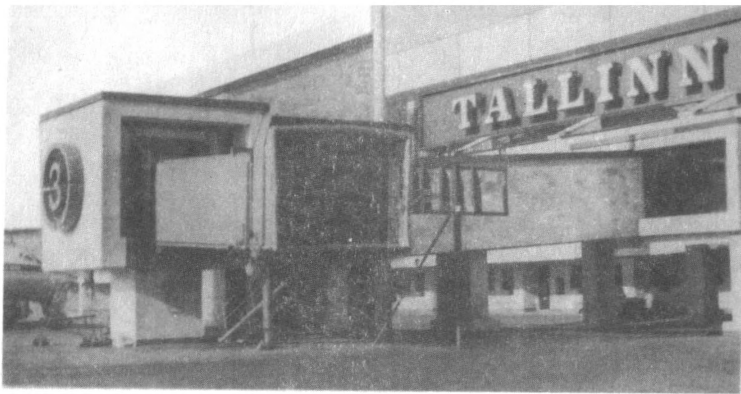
Стационарная перронная галерея, решенная в сборных железобетонных конструкциях, облицованная сааремским доломитом в аэровокзале Таллинн
